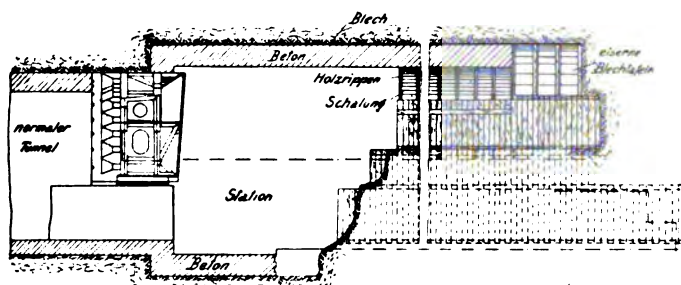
Längsschnitt des Tunnels in der Atlantic Avenue-Station während des Baues.
